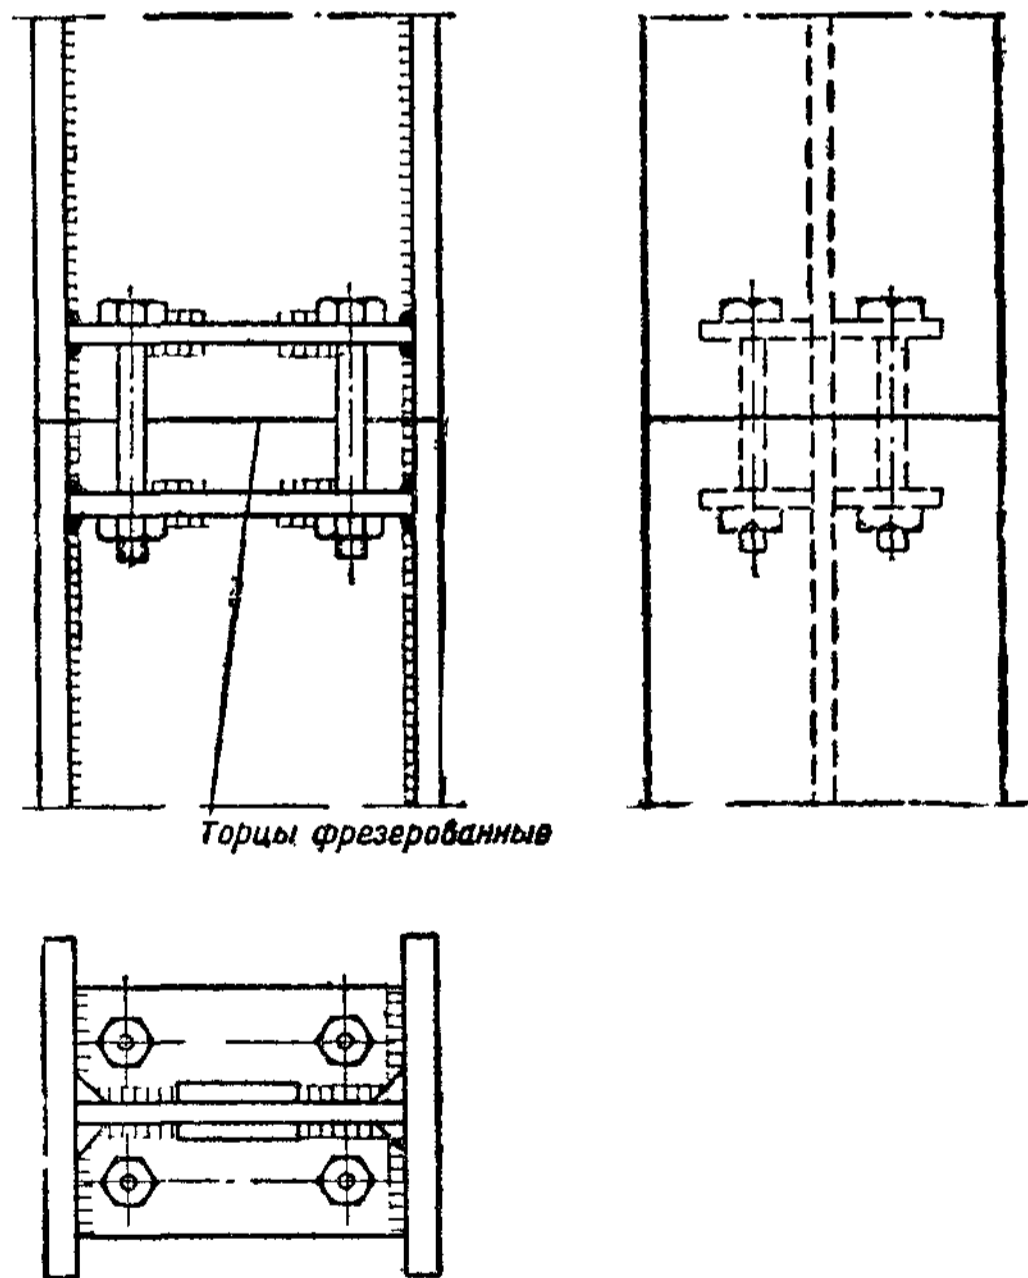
Стык колонны с фрезерованными торцами и стяжными болтами
